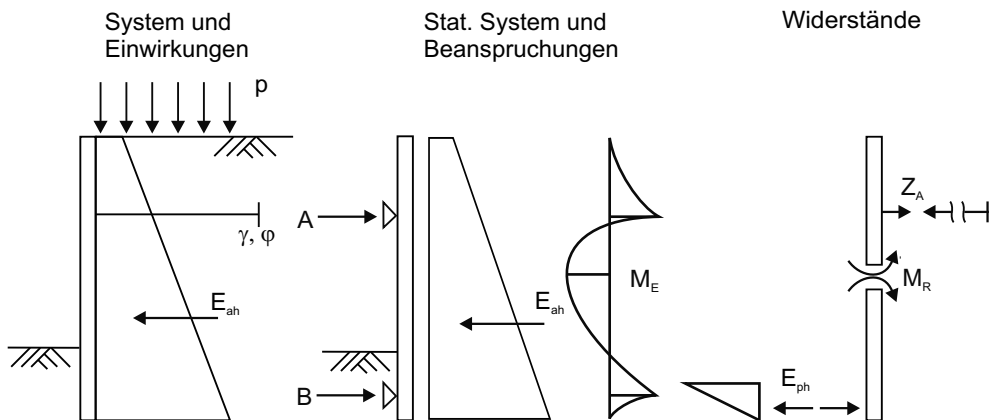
Einwirkungen, Beanspruchungen und Widerstände bei einer Spundwand
